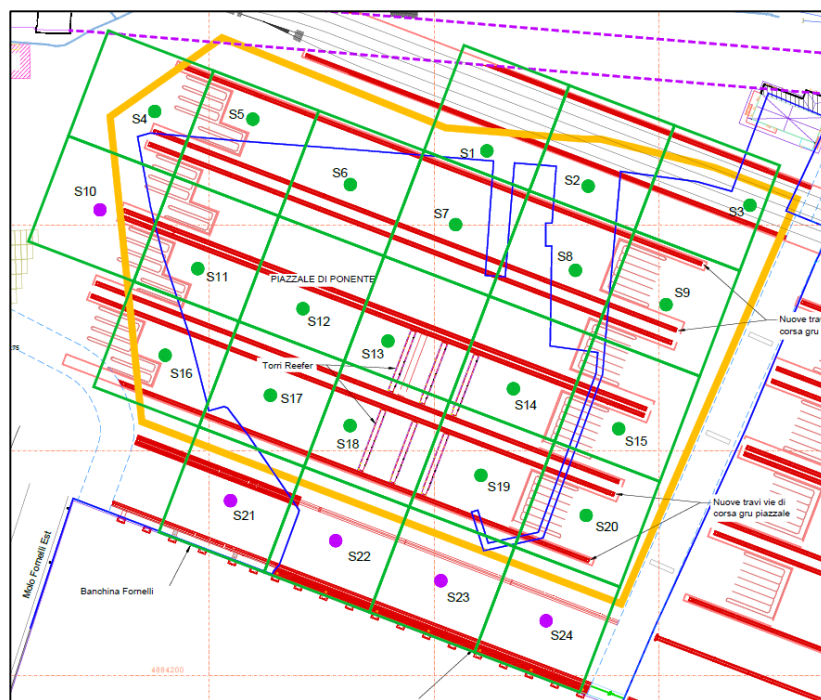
Piazzale Ponente: planimetria con indicazione delle stazioni di monitoraggio
